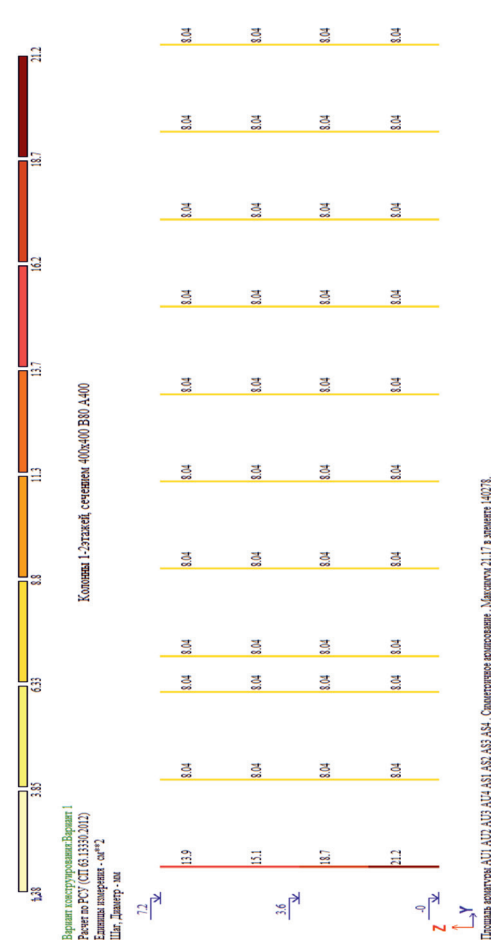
Армирование колонн 1 и 2 этажей по осям 6, 7. Сечение 400х400, бетон В80
